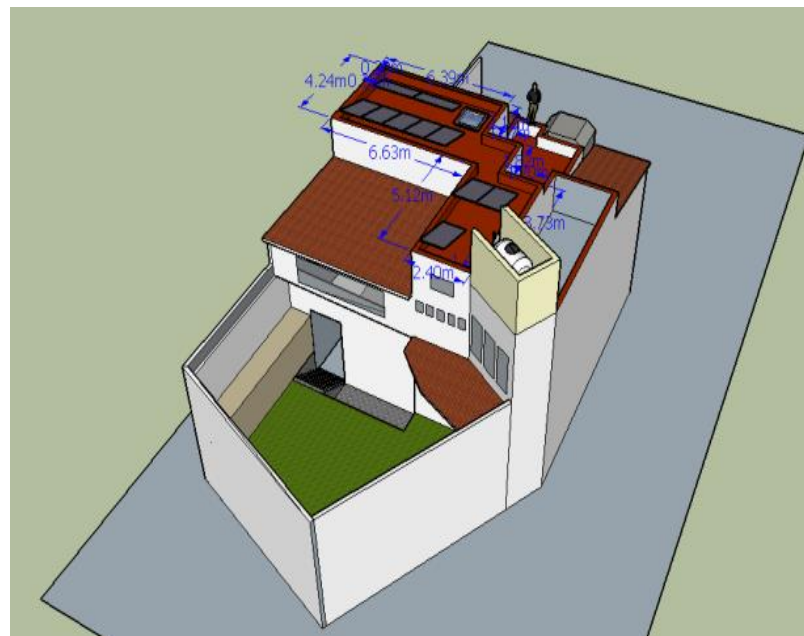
Plano 3D, vista superior: aporte propio.
